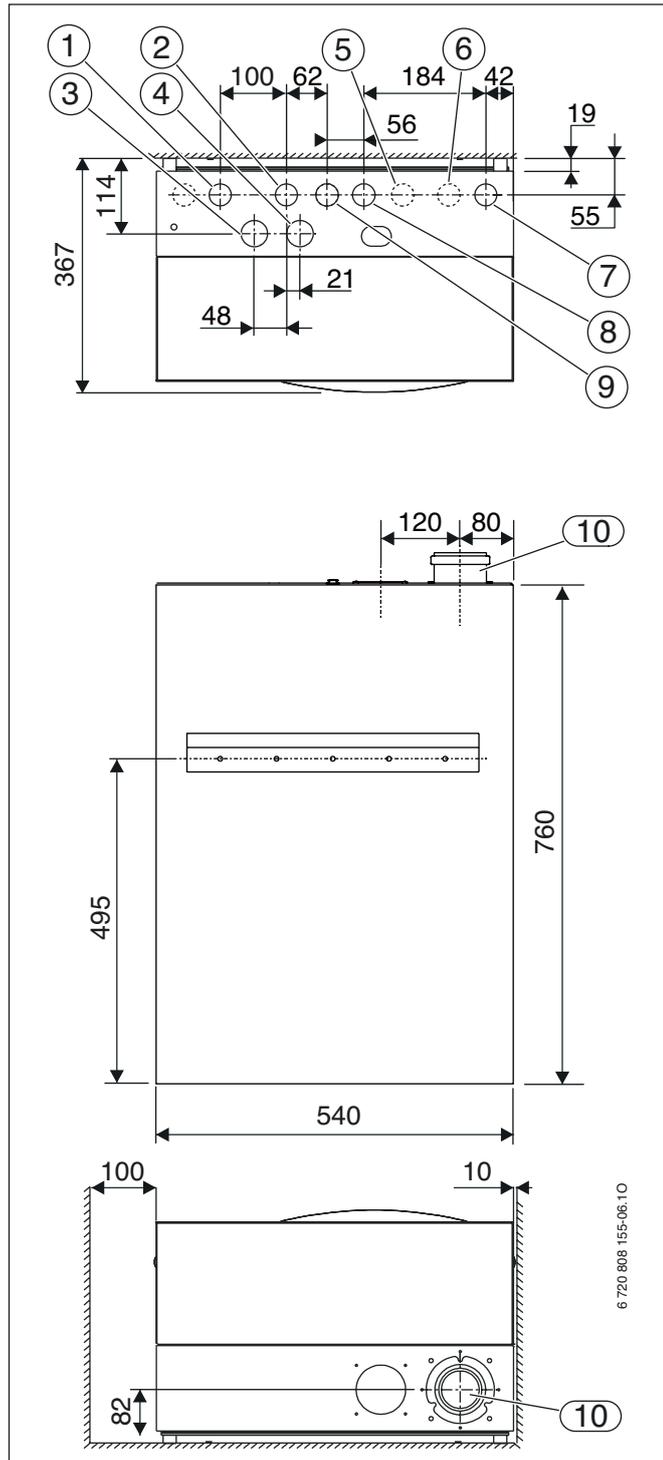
THR 0.9 C/DC, THR 2-17 C/DC e THR 5-25 C/DC (dimensioni in mm)
